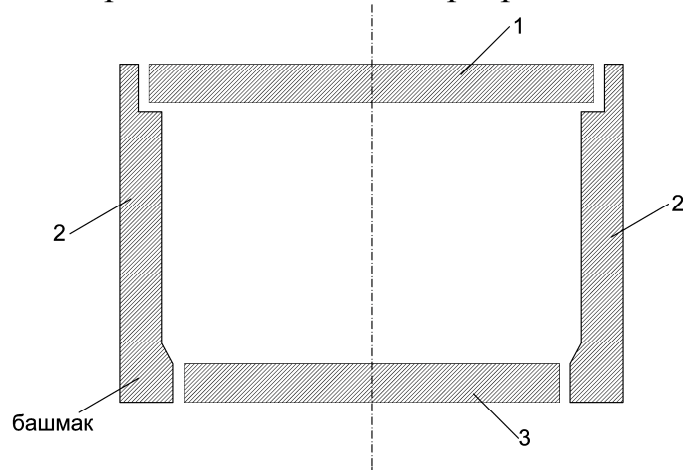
Поперечное сечение тоннеля плитной конструкции:
